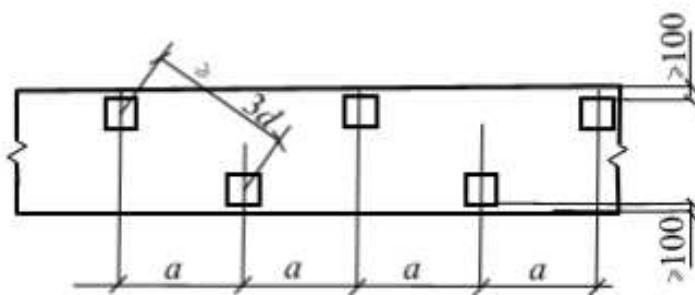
Схема расположения свай в рядовом фундаменте
